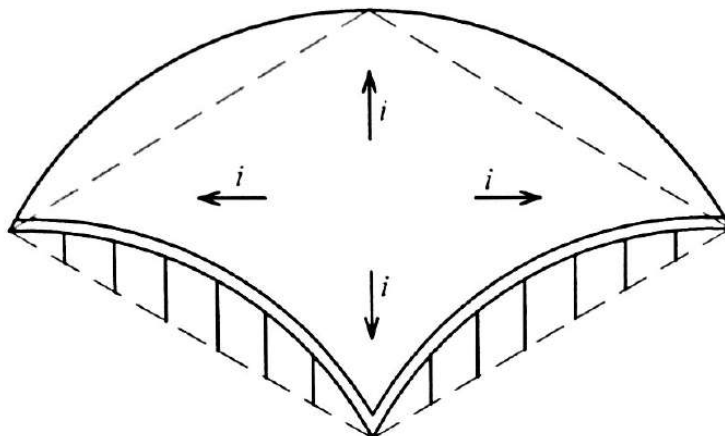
Пологая оболочка с криволинейным опорным арочным контуром по каждой из четырех плоскостей с опиранием на ряд колонн в пролетах арок и на фундаменты по углам плана
